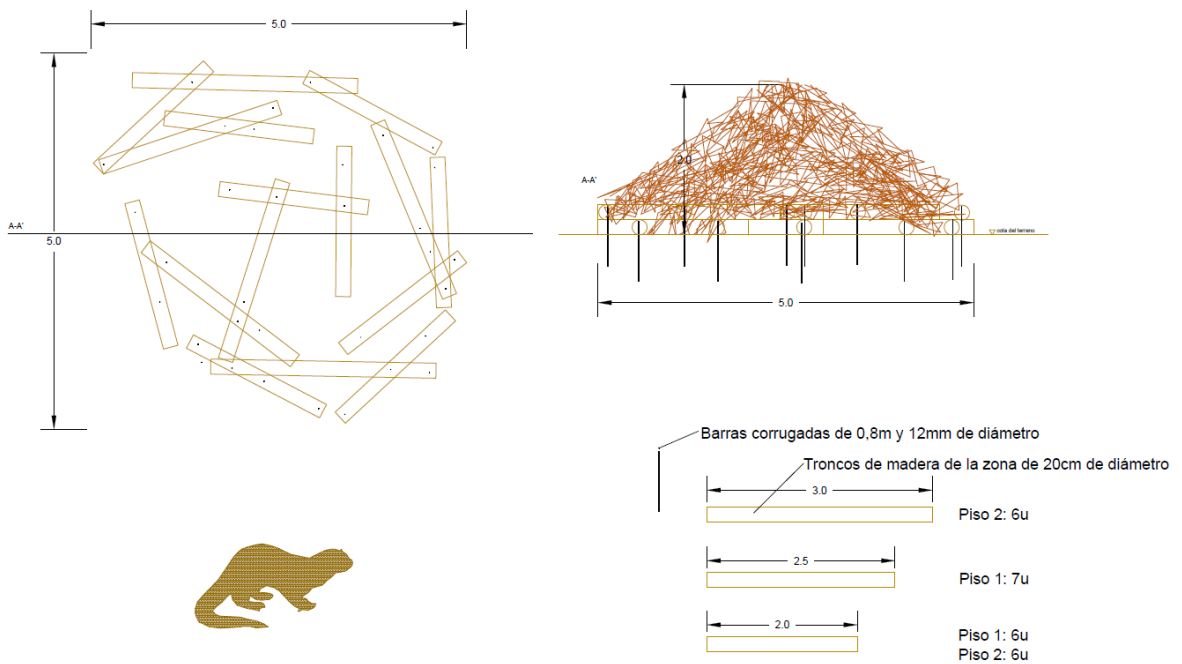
Detalle constructivo y ejemplo estructuras para refugio de fauna
